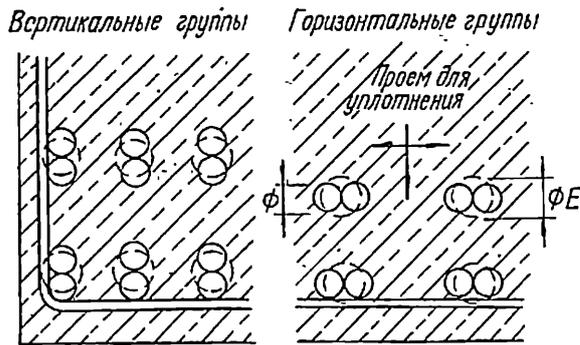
2. Группы из двух соприкасающихся стержней
